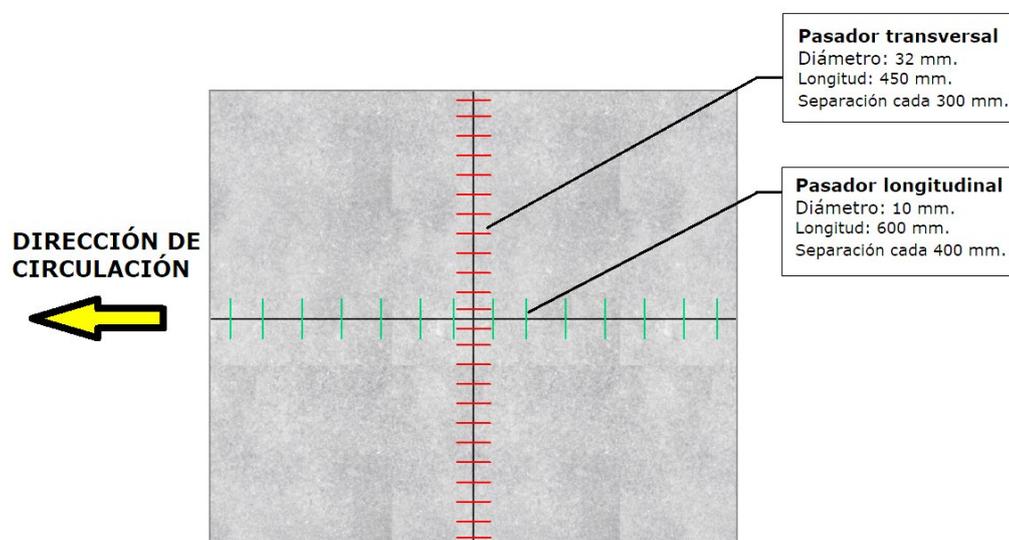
Juntas de pavimento. Fuente: elaboración propia.
